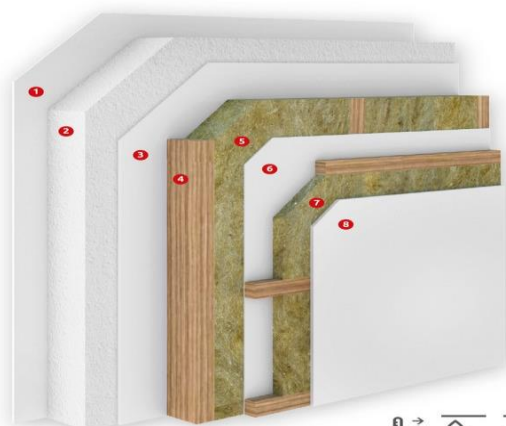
Difuzně otevřená skladba konstrukce firmy Lucernstav, s. r. o. (www.lucern.cz, 2017-03-11).
